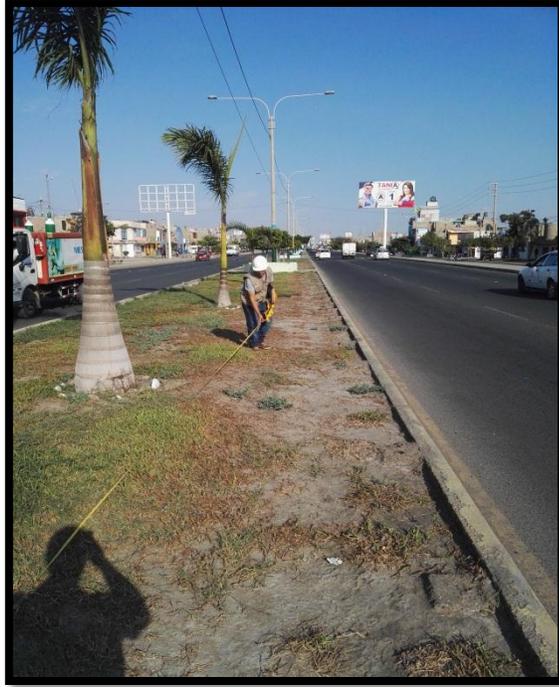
Medición insitu de berma central Avenida Prolog. Jose Pardo
